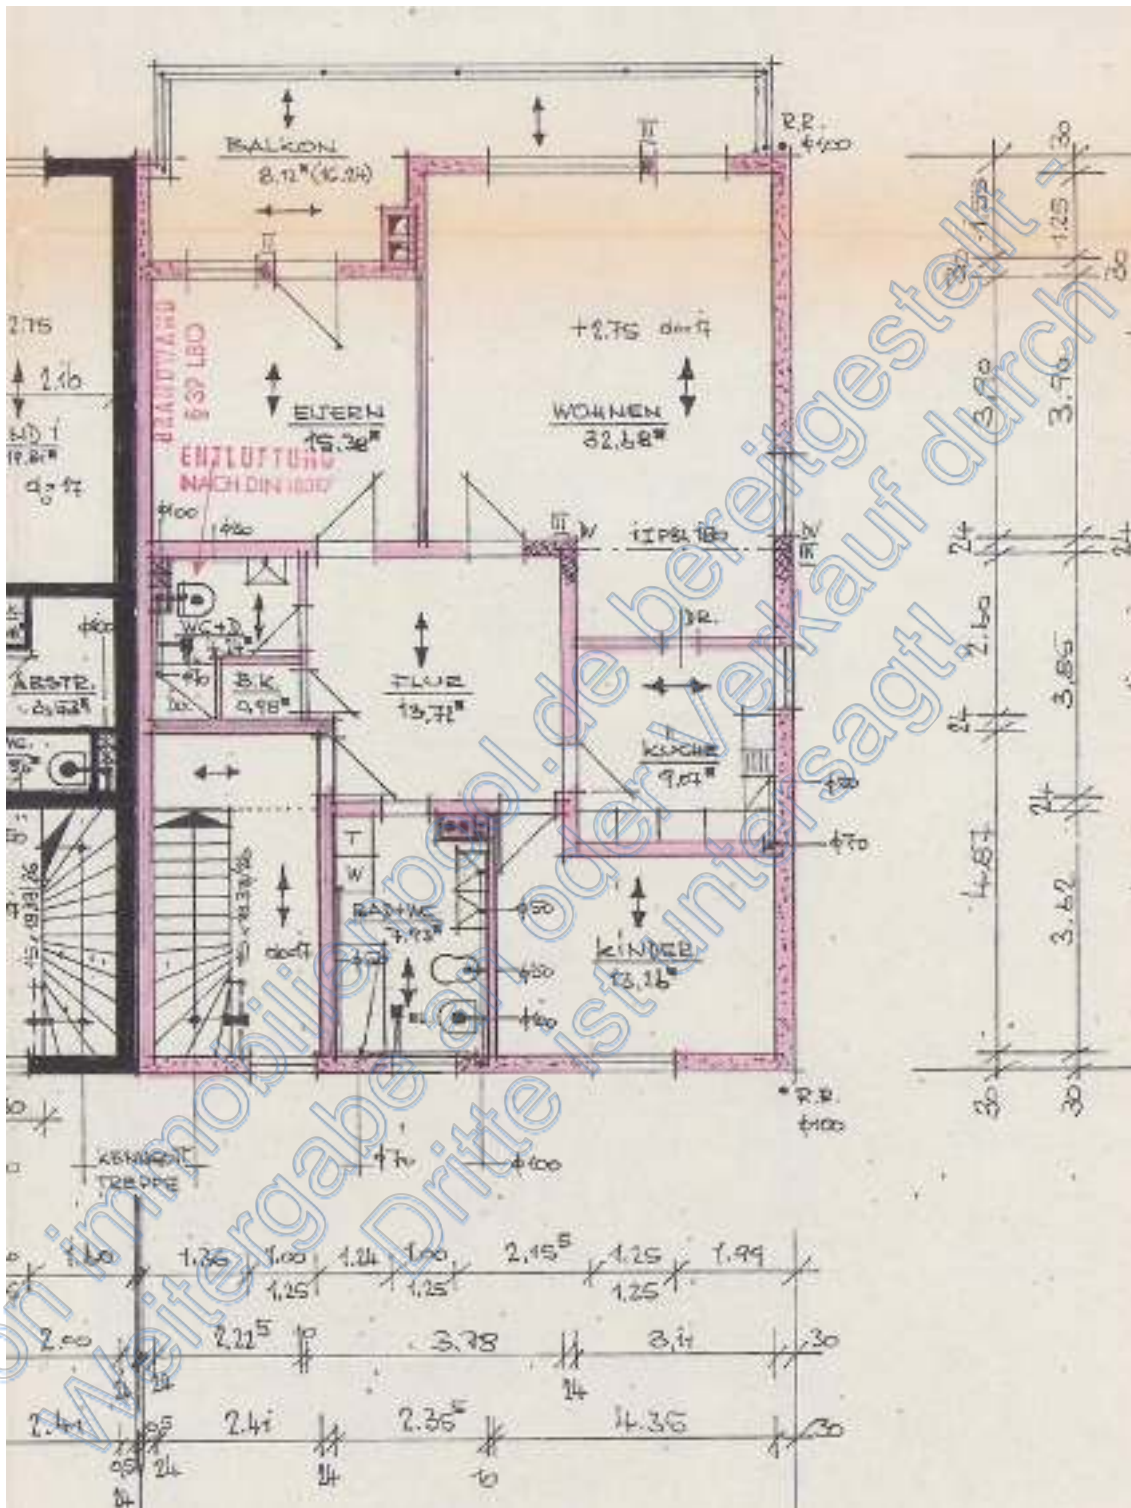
Grundrissplan Obergeschoss (aus Bauakte)
